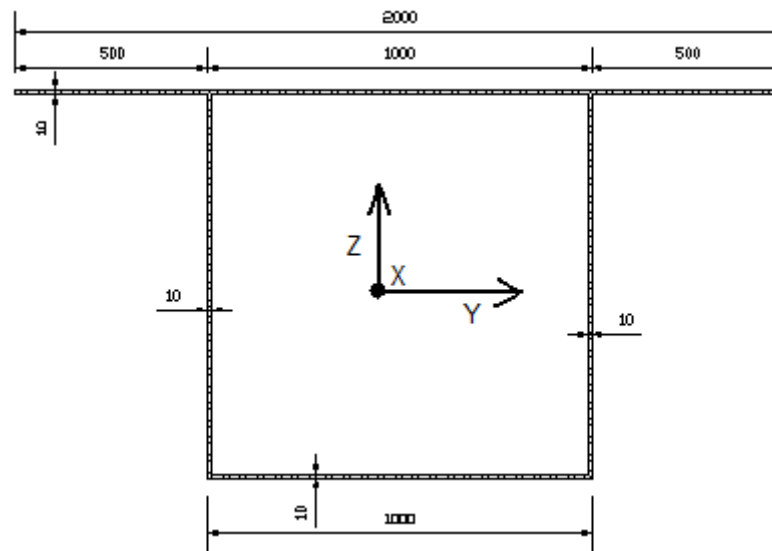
Secção transversal do tabuleiro ponte em estudo (mm)
